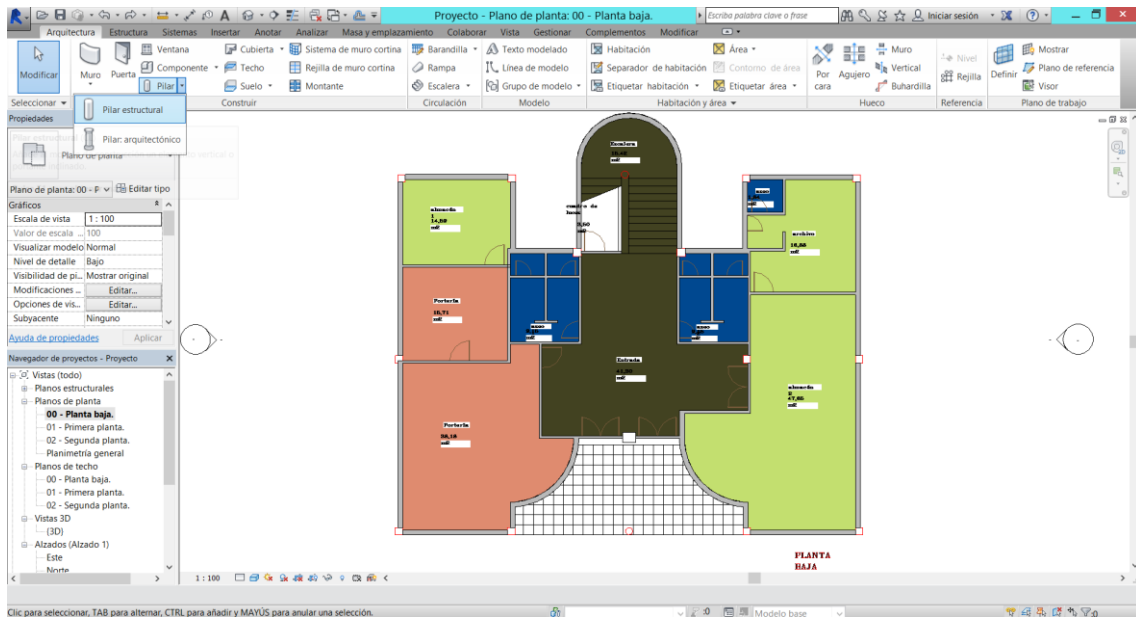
Selección del tipo de pilar. Fuente: Elaboración propia.
